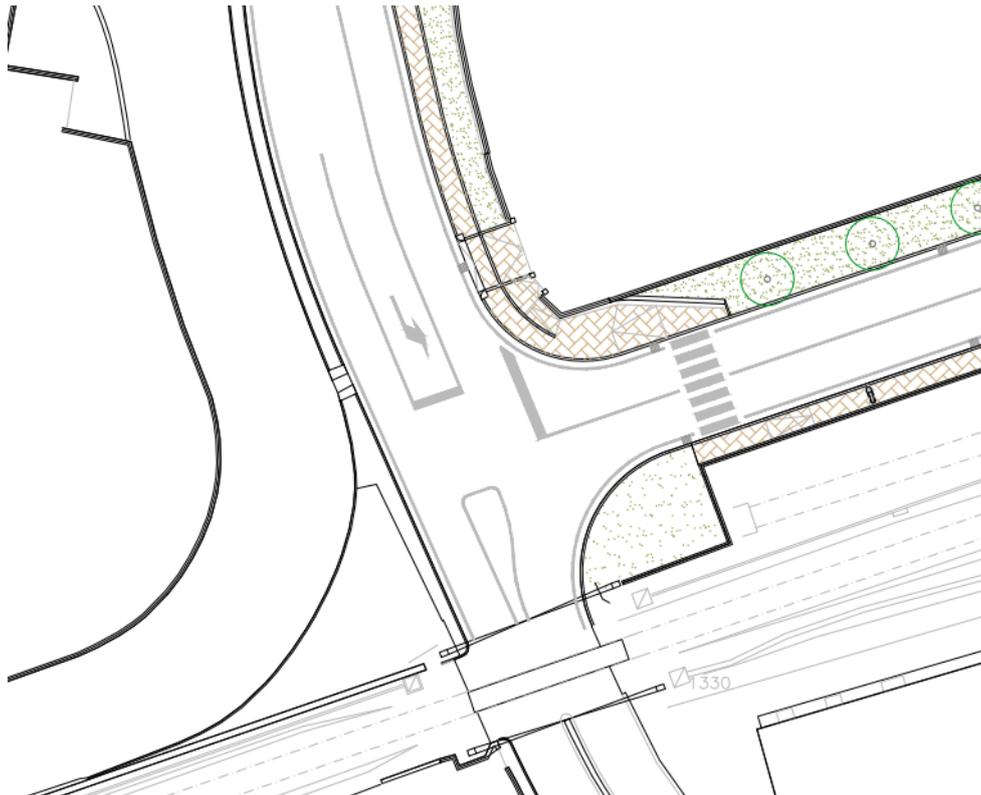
Planimetria del progetto di riforma dell'intersezione Via Vallosa e Via Stazione
